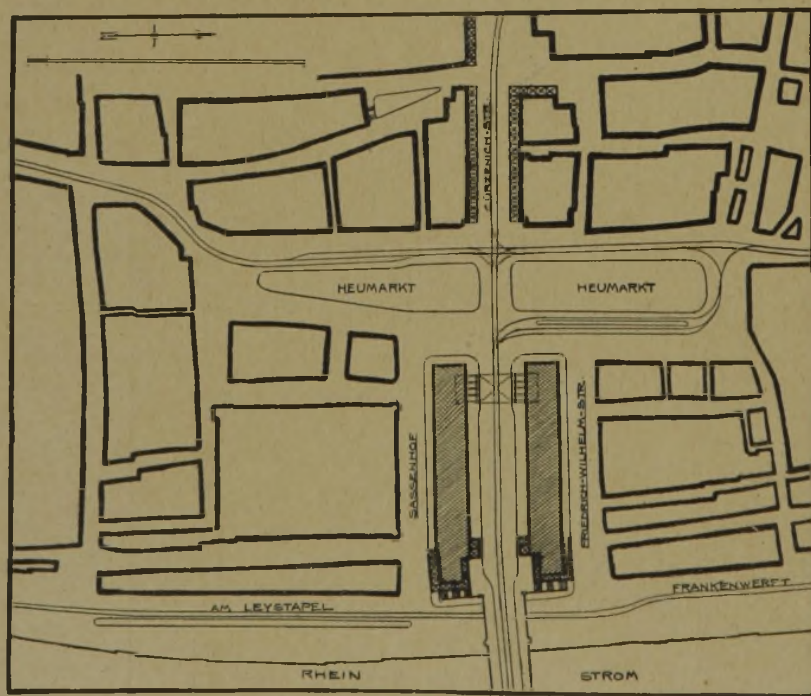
Lageplan des linksrheinischen Brückenkopfes. (1:4000.)
